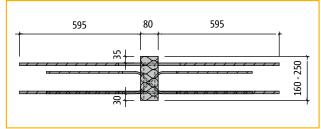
Liaison rupteur Schöck Isokorb® modèle D : balcon préfabriqué et plancher préfabriqué
